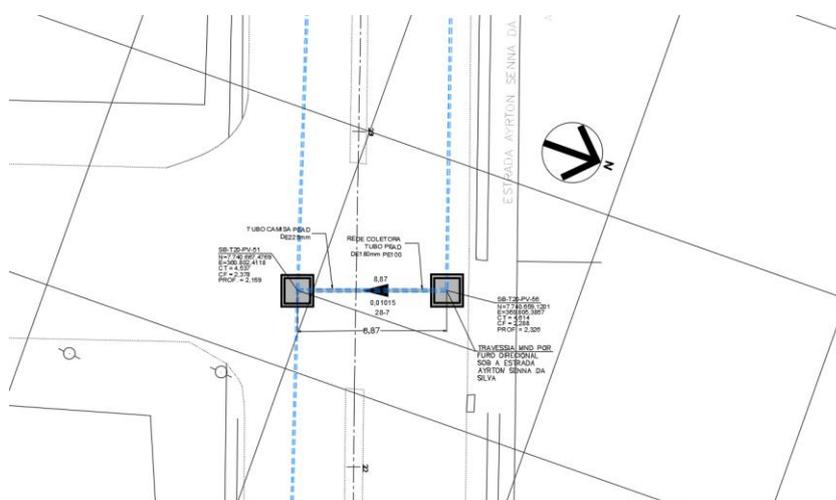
Planta de localização da travessia SB-T20 PV-51 AO PV-56
